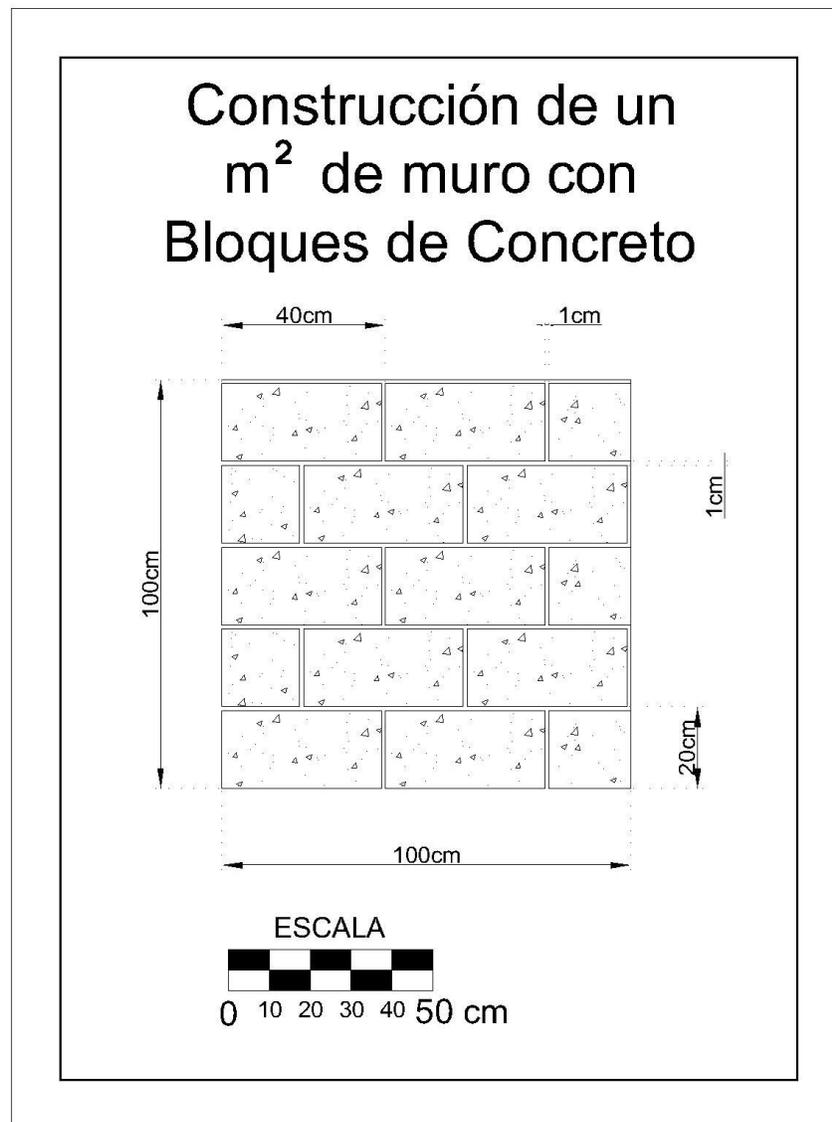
Construcción de un m^2 de muro con Bloques de Concreto
